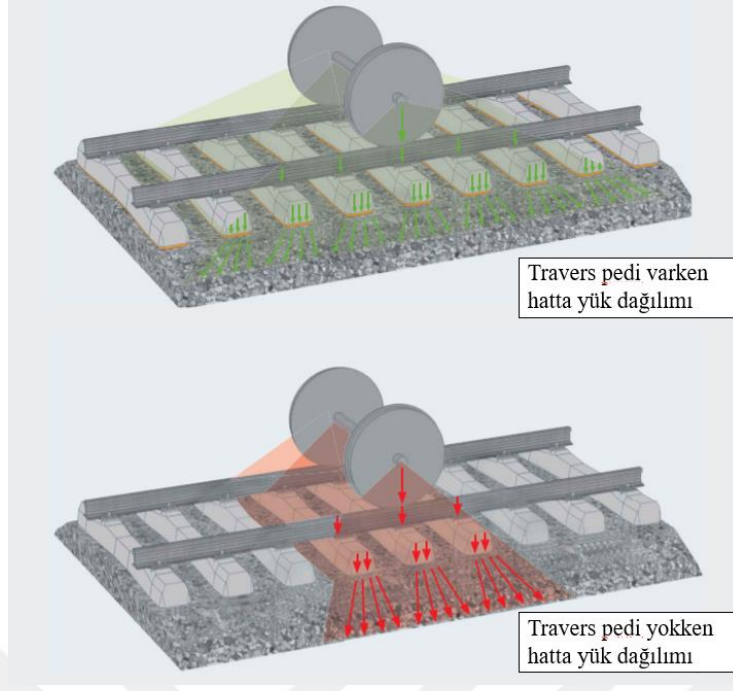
Travers altı ped kullanılan sistem kesiti
